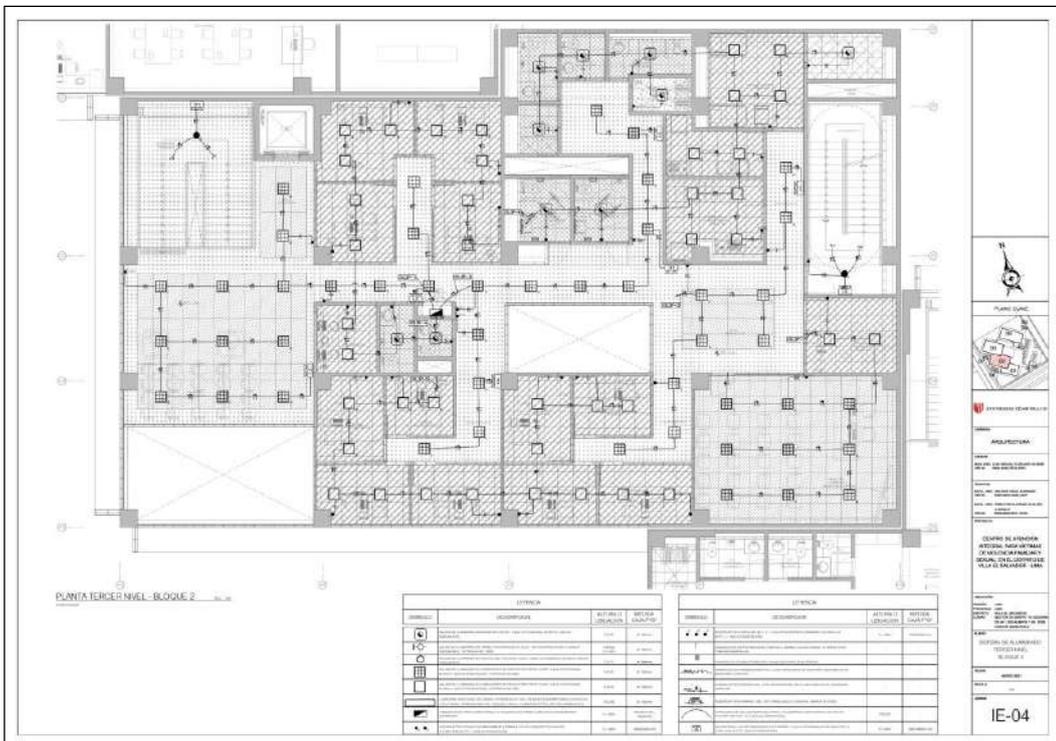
Planta tercer nivel sistema de alumbrado – bloque 2.
